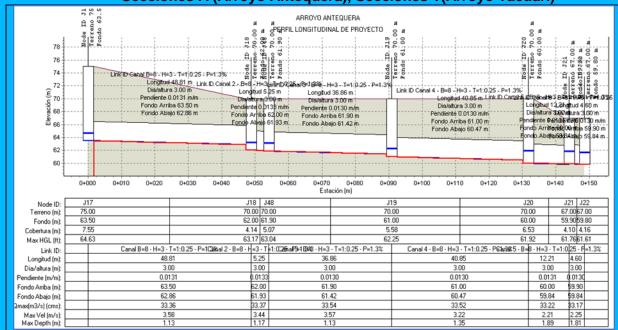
Perfil longitudinal de un sector del Arroyo Antequera.
